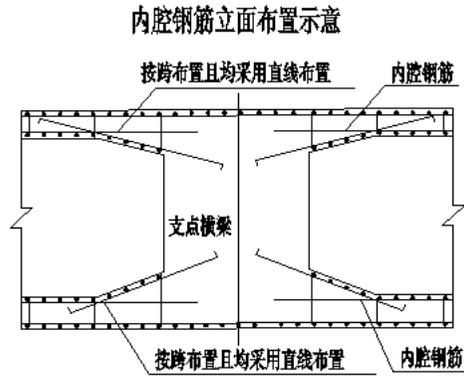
箱梁钢筋-各孔内腔钢筋布置-直线布置
